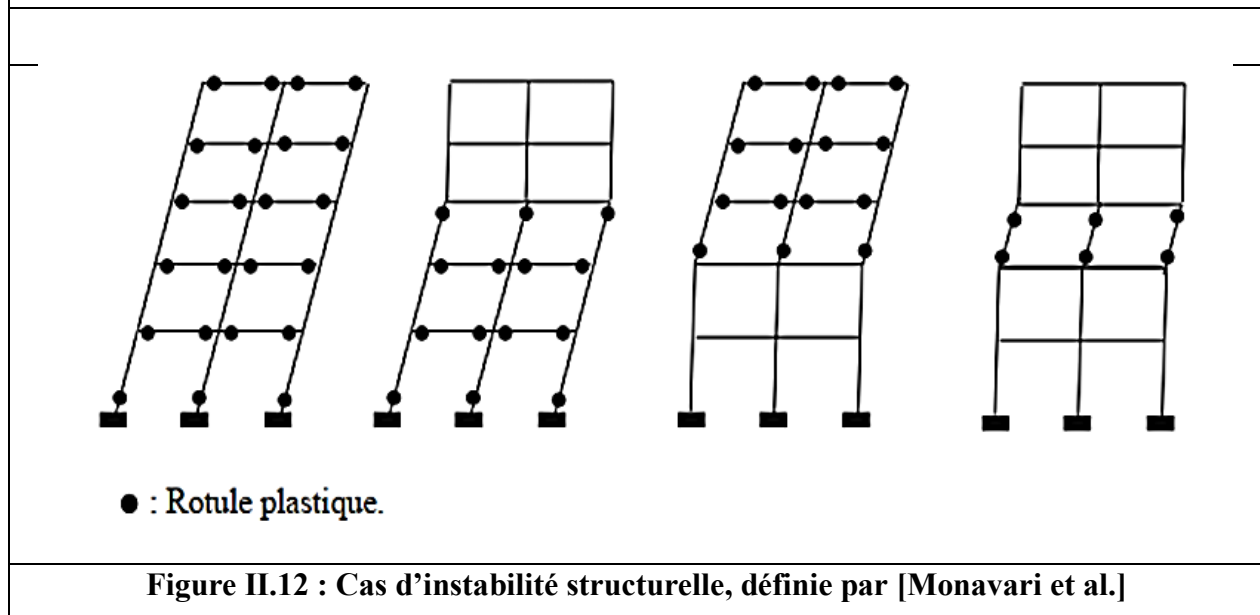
Cas d'instabilité structurelle, définie par [Monavari et al.]
